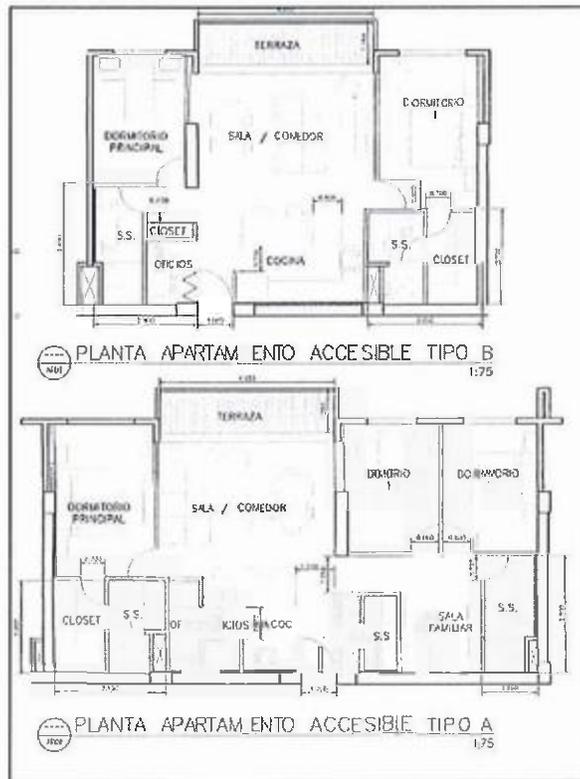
Tipos de Apartamentos - Fuente: Plano Arquitectónico
